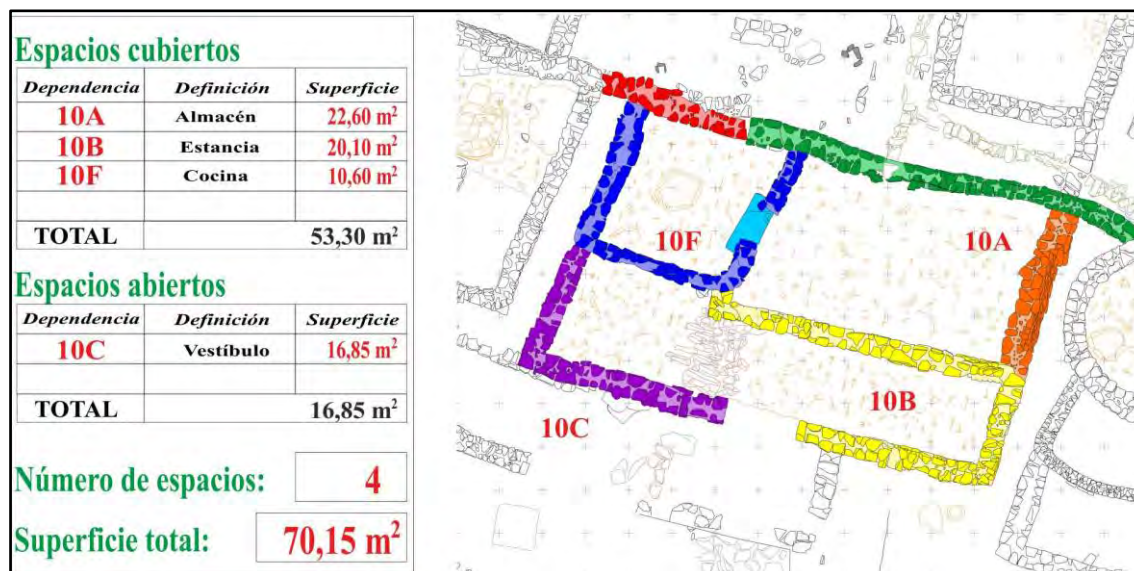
Planta que refleja los espacios de la unidad 10 y las distintas estructuras murarias construidas en distintos colores
